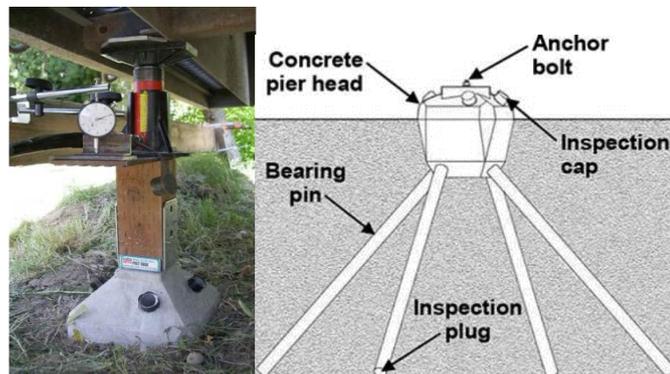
Estructura de apoyo al piso, cimentación y piezas de acero.
